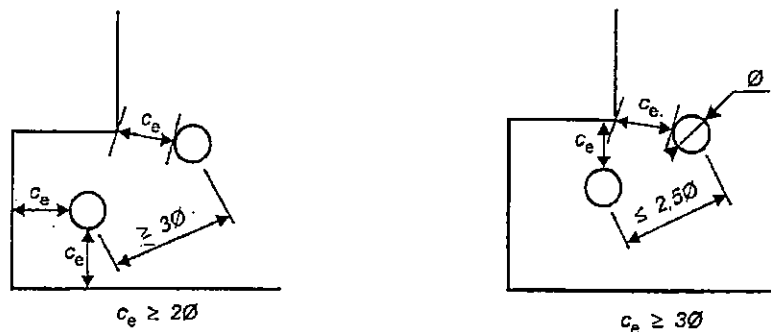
Distanza minima  $c_e$  per armature da precompressione
